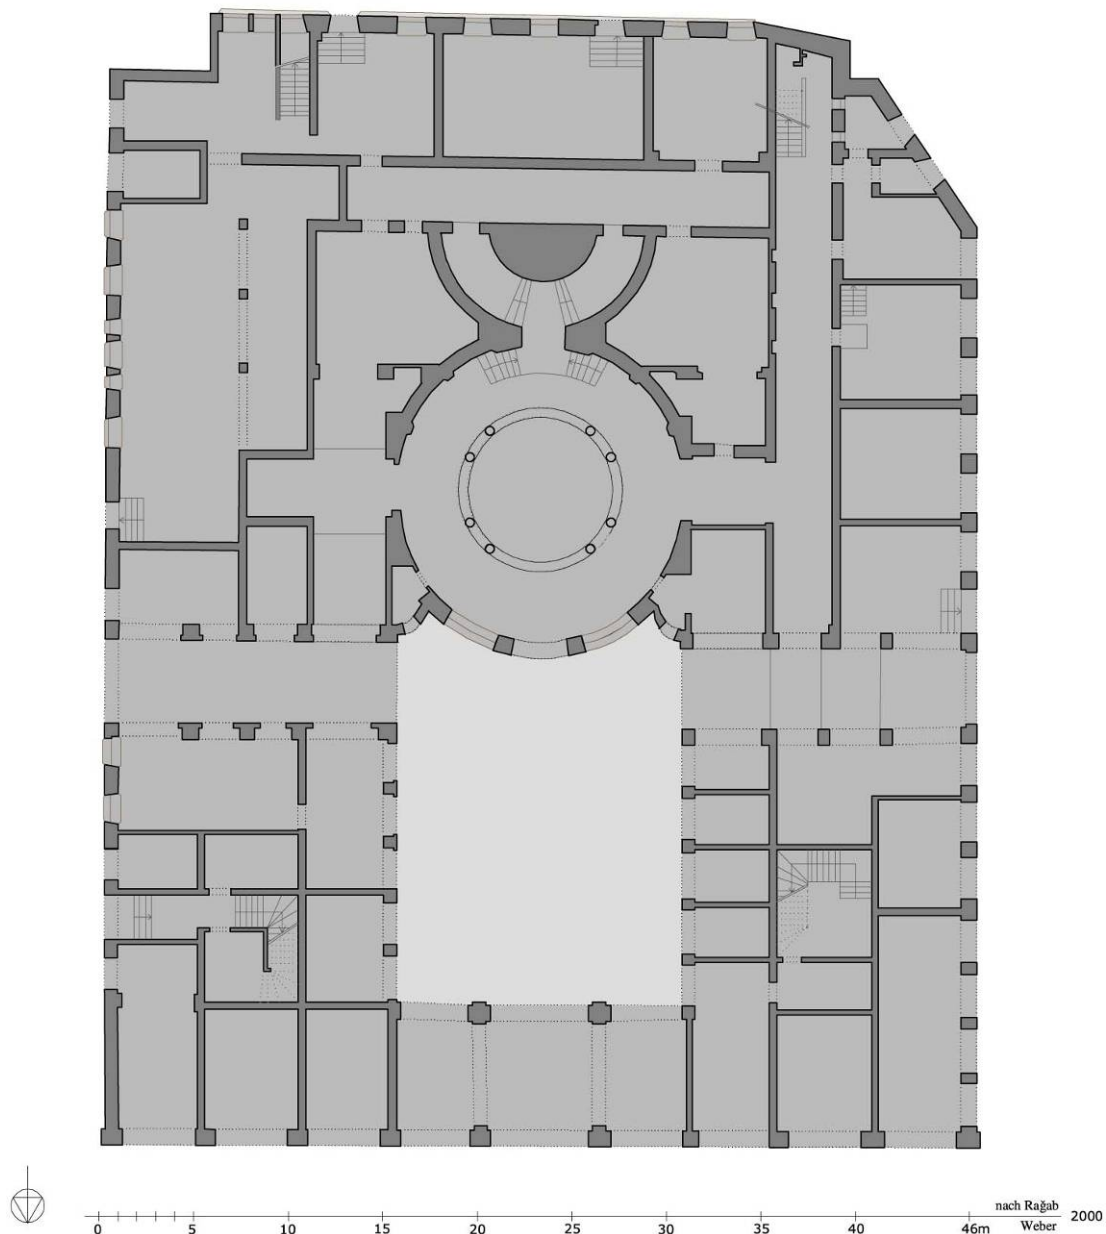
Handelsgebäude al-‘Ābid, Grundriss EG
